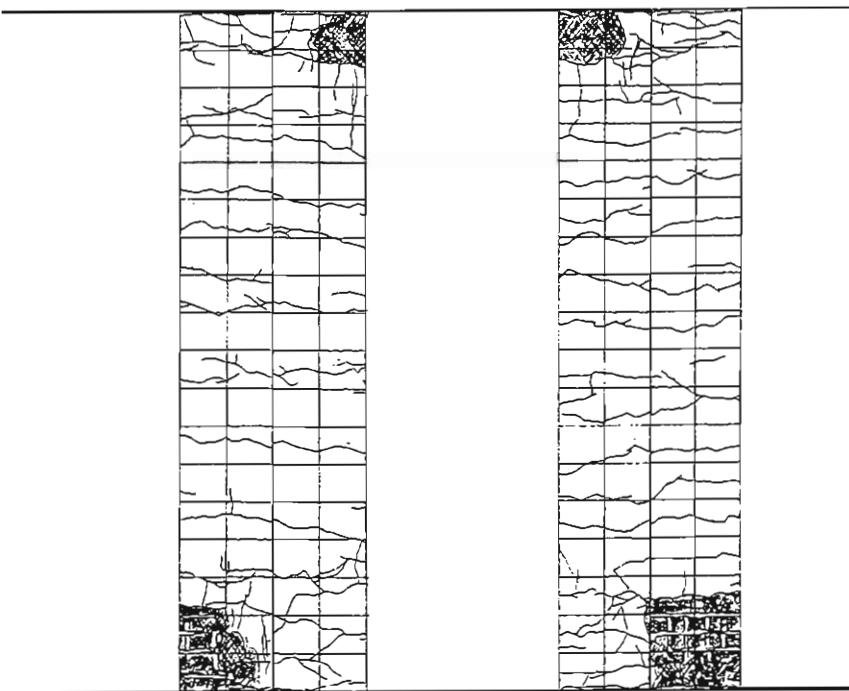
桁体のひび割れ状況展開図 (ケース 2、 4 δy)
